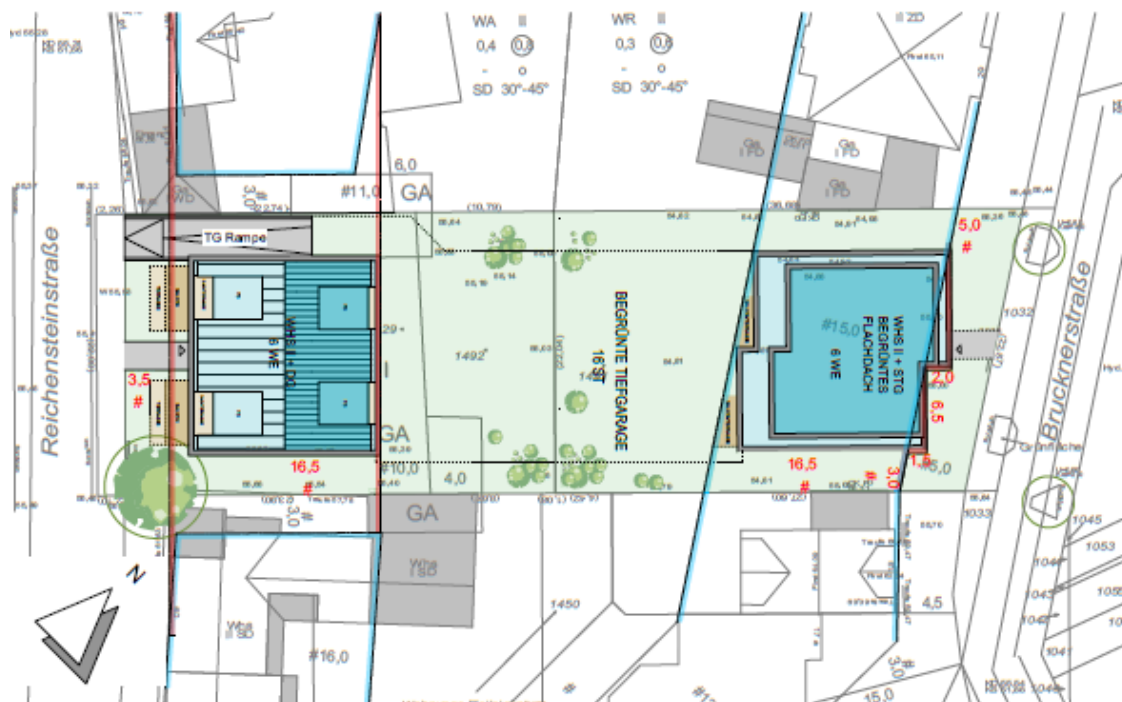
Entwurf überbaubare Flächen mit geplanten Wohngebäuden und Tiefgarage im Änderungsbereich
